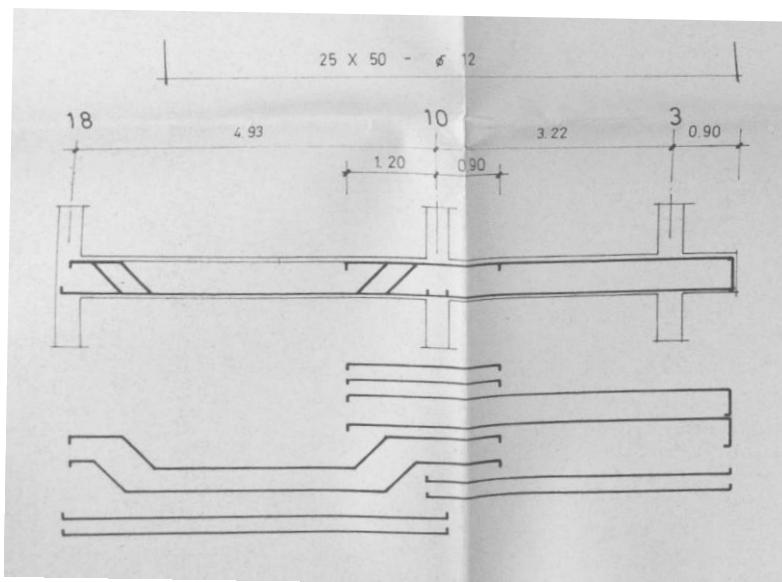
Despiece de armado de la viga (acero REA). Edificio ficha 209A.014, 1972.
